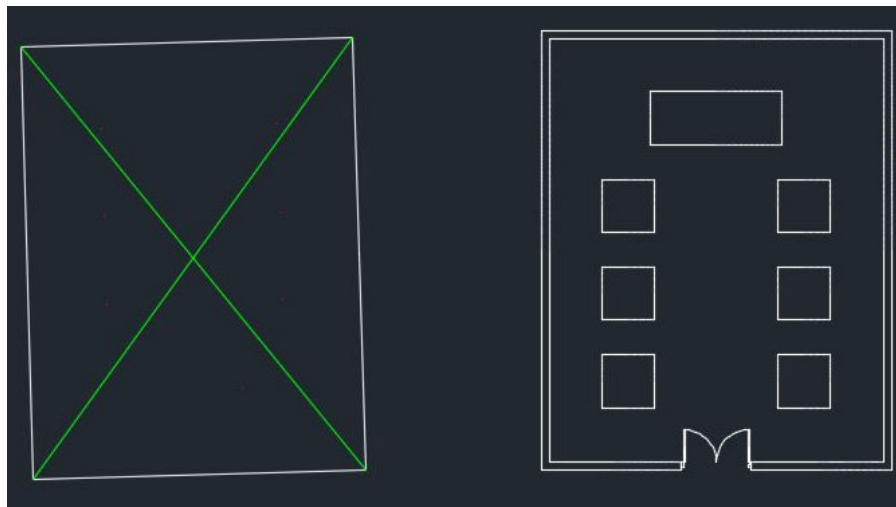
Planos de la planta del edificio. A la izquierda se muestra el plano obtenido tras realizar el levantamiento del interior del Pabellón. A la derecha se muestra el plano en planta de los planos iniciales. Se puede observar la desorientación existente.
